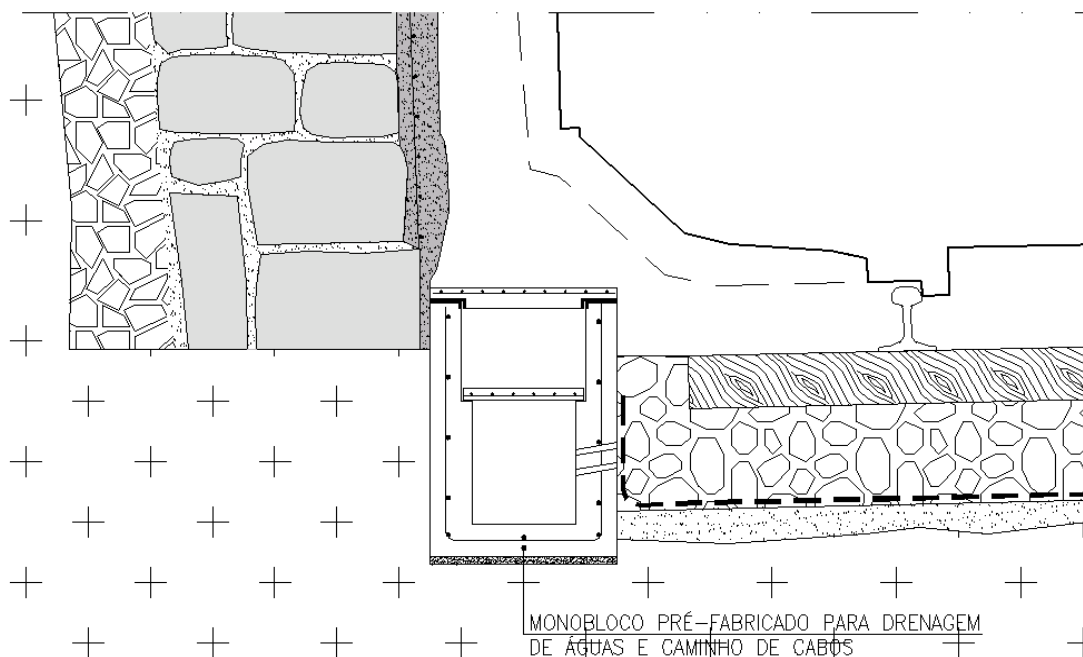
Monobloco pré-fabricado em betão armado para drenagem de águas e caminho de cabos (GEG)
